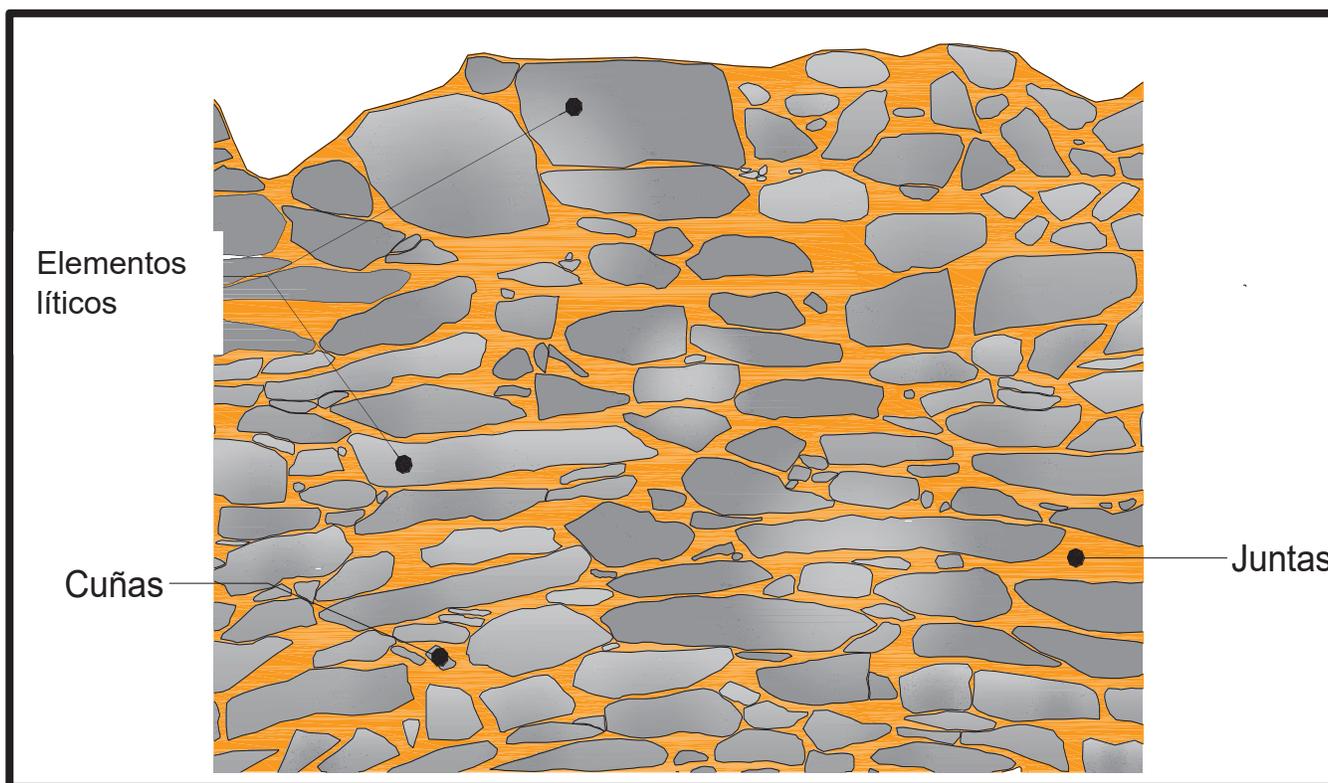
Mampostería ordinaria y aparejo irregular, redibujado en Autocad de la estructura Em-22.
